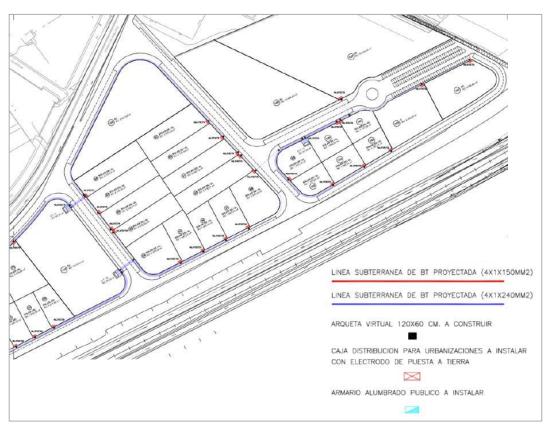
Plano de la red de baja tensión (fuente: Proyecto)
